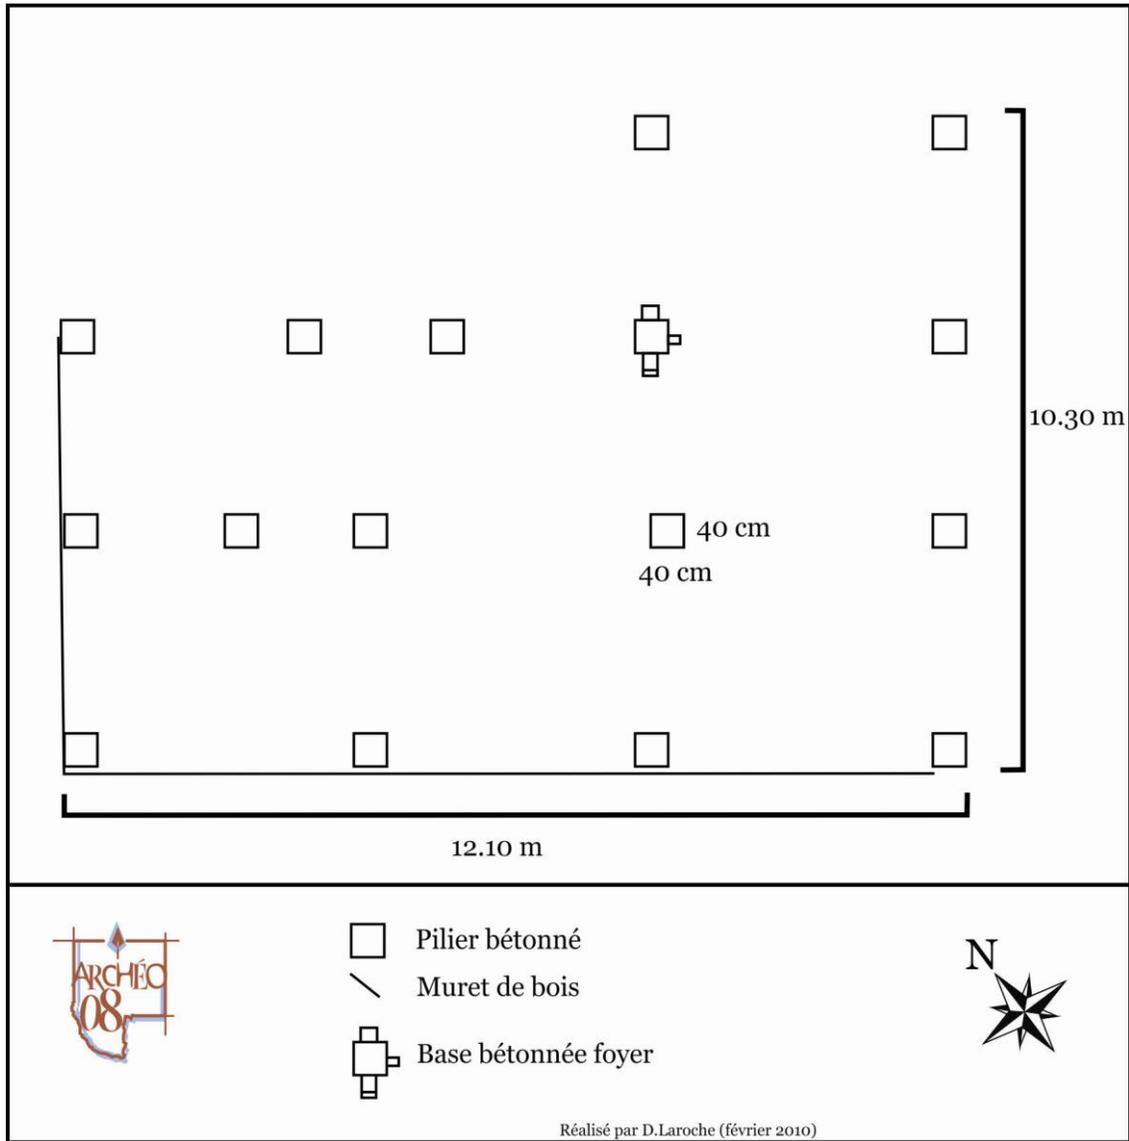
Plan de la structure 3, secteur 3, projet n°154-86-0721
